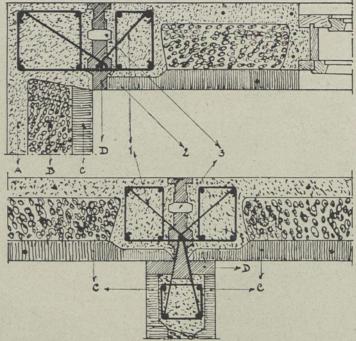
Wandkonstruktion der "Occident"=Bauweise (armierte Betonplatte, außen Kiesbeton; in der Mitte Schlackenfüllung, innen Schlackenbeton).
